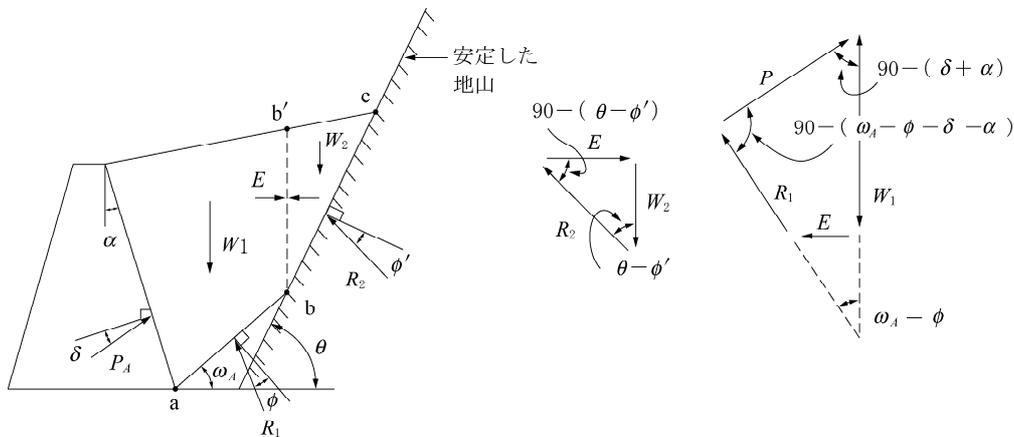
切土部土圧の算定法 (その 2) ⁸⁾
